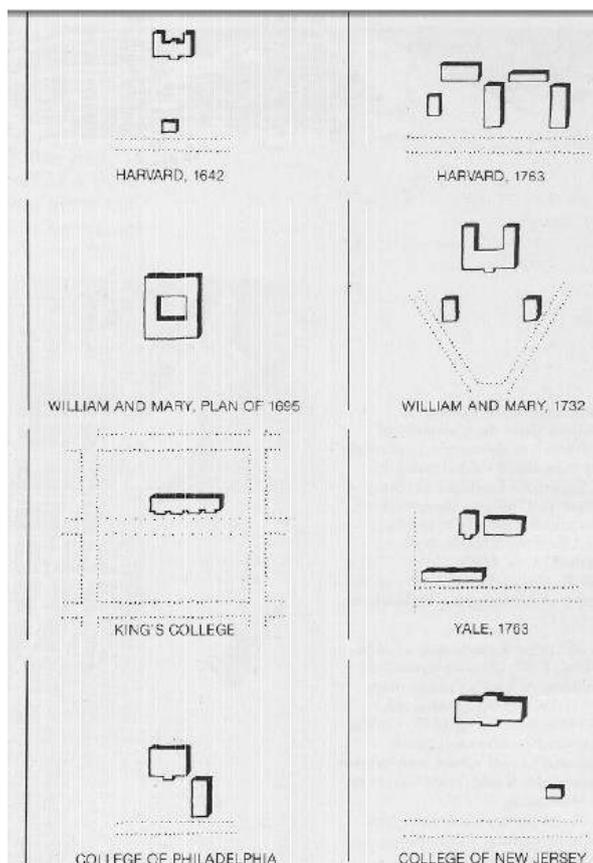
Planos esquemáticos dos *colleges* americanos. Fonte: Turner (1984 p. 19)
